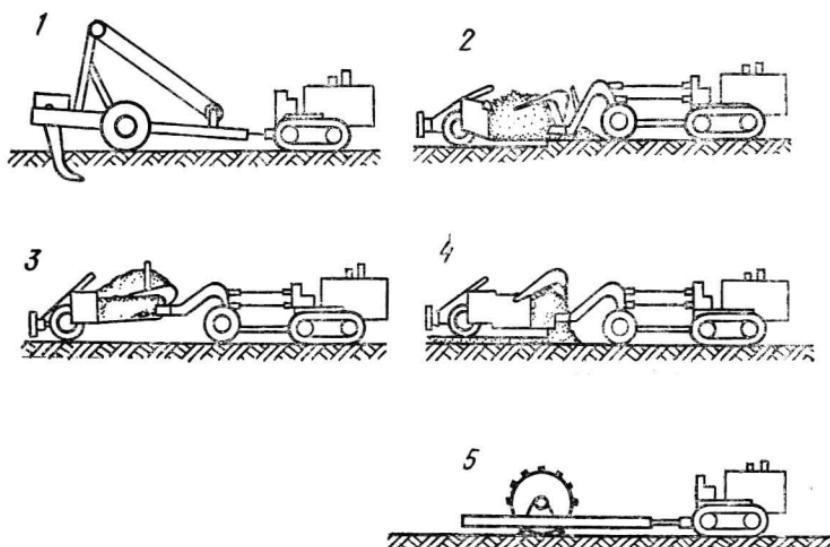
Схема комплексной механизации земляных работ при разработке грунта скрепером
